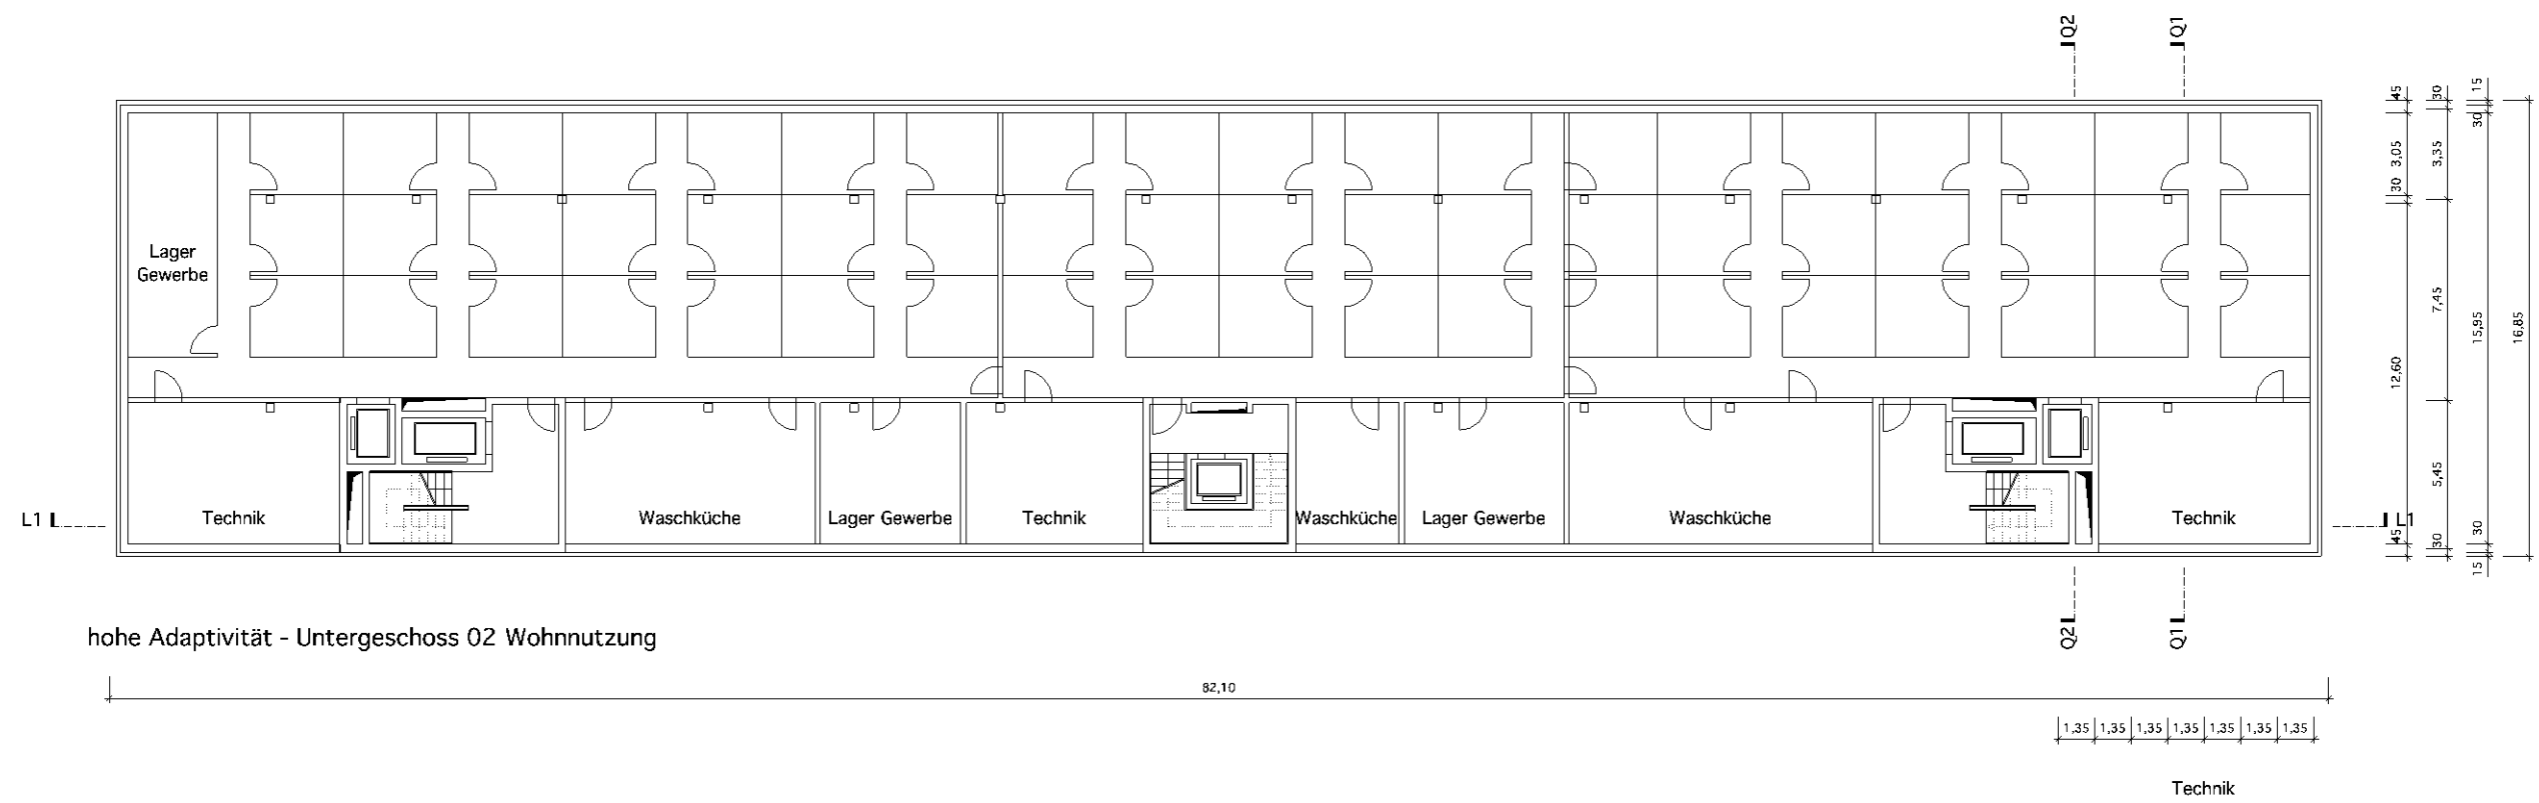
Grundriss Untergeschoss 02 des Referenzgebäudes „hohe Adaptivität“ für eine Wohnnutzung
